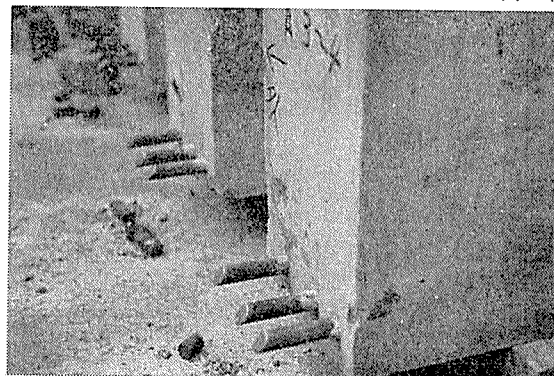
側ばりの下端鉄筋のプレキャストブロック側の端部
